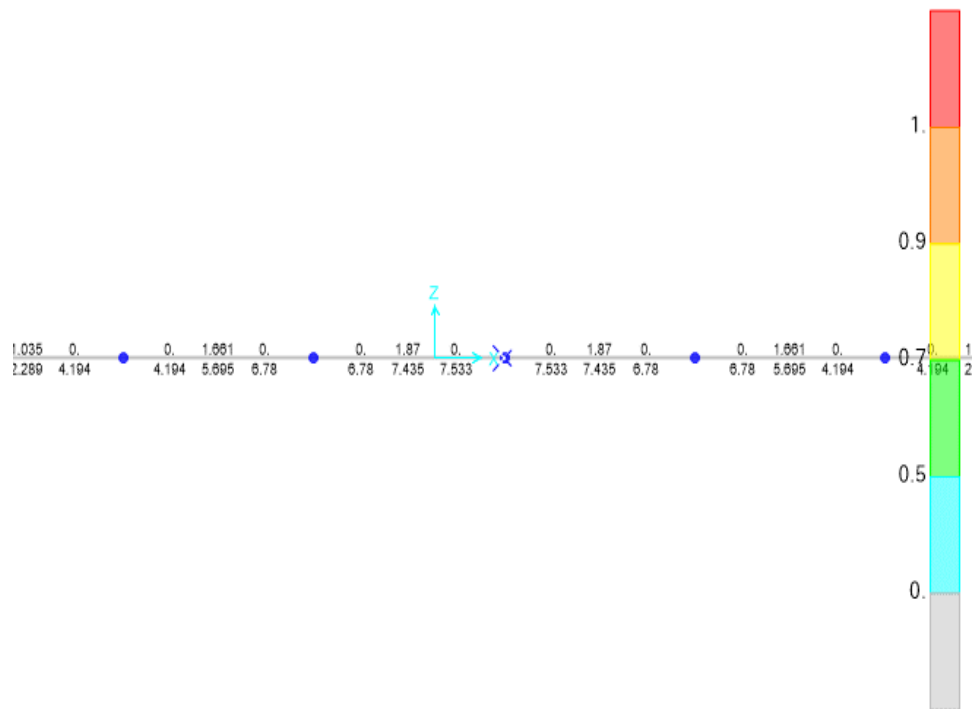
Requerimiento de refuerzo transversal rampa acceso semisótano.
